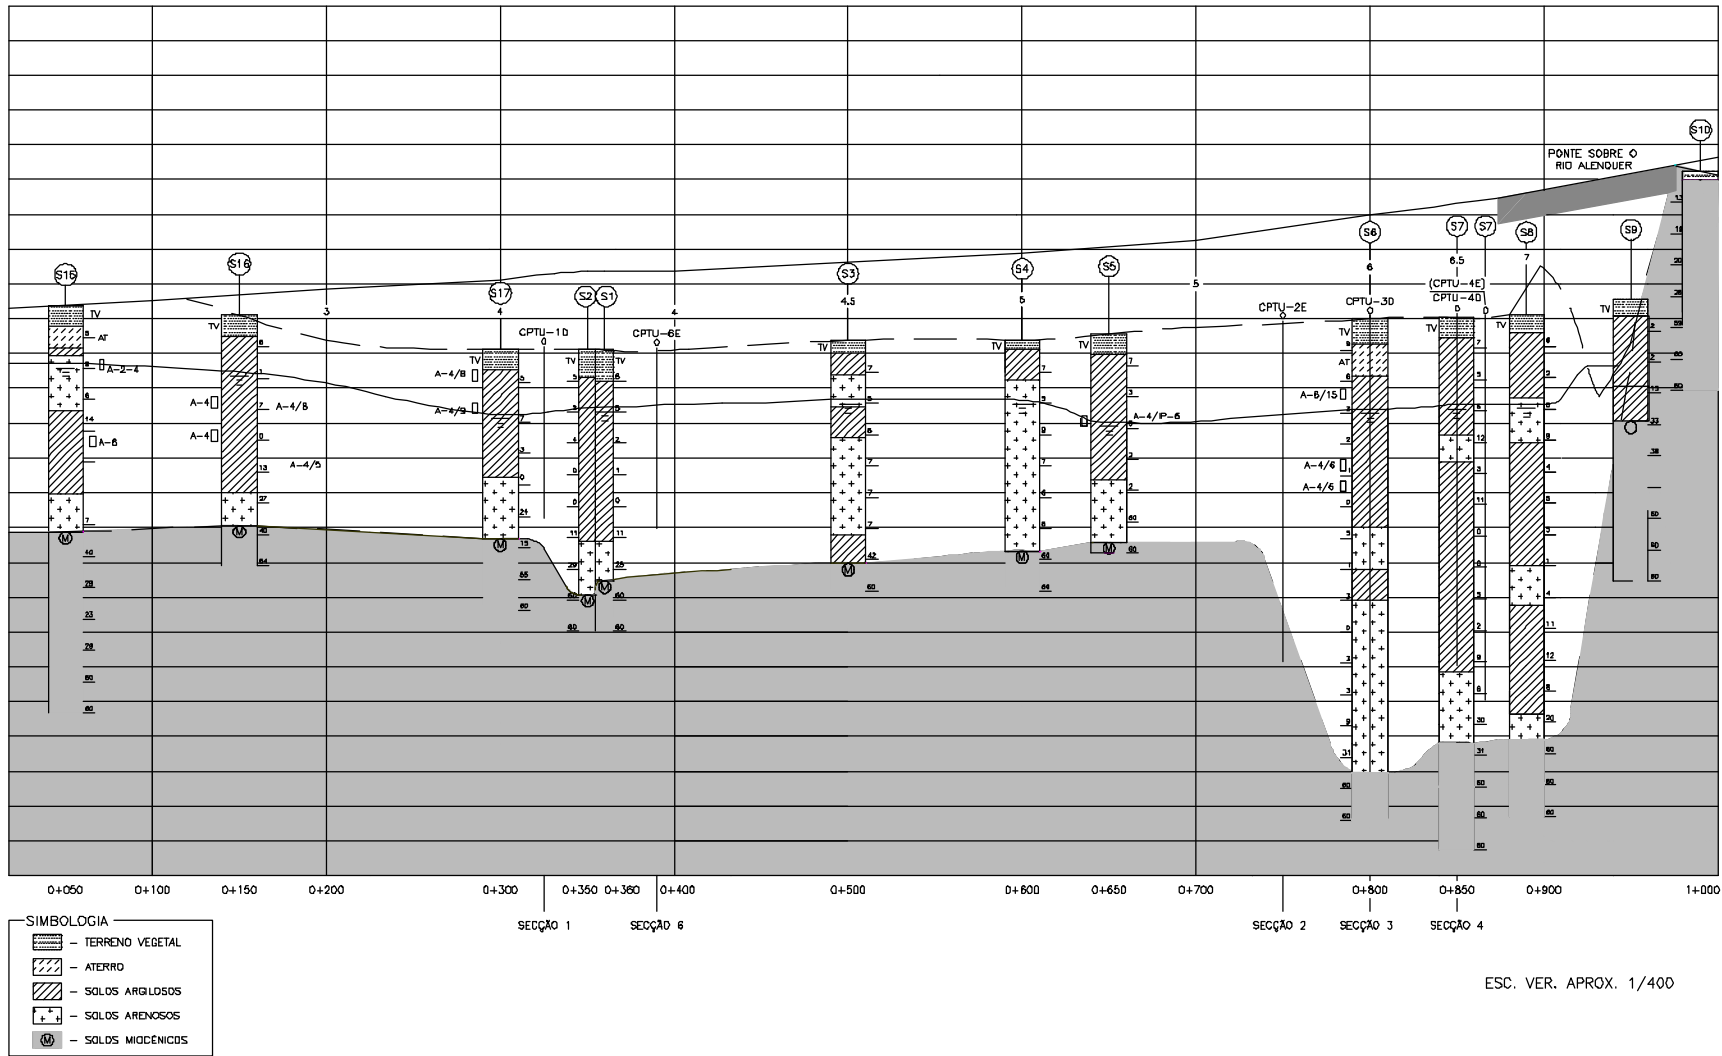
Perfil Geotécnico Interpretativo (longitudinal)
